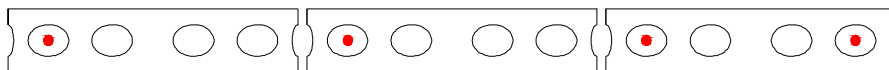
Esquema de refuerzo horizontal para murete M4.
